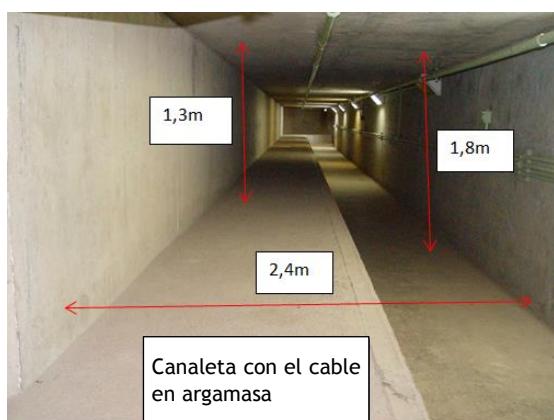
a la izquierda: Vista de la continuación de la galería en dirección a los terminales. (corte A-A de 6641-DF-88805)
